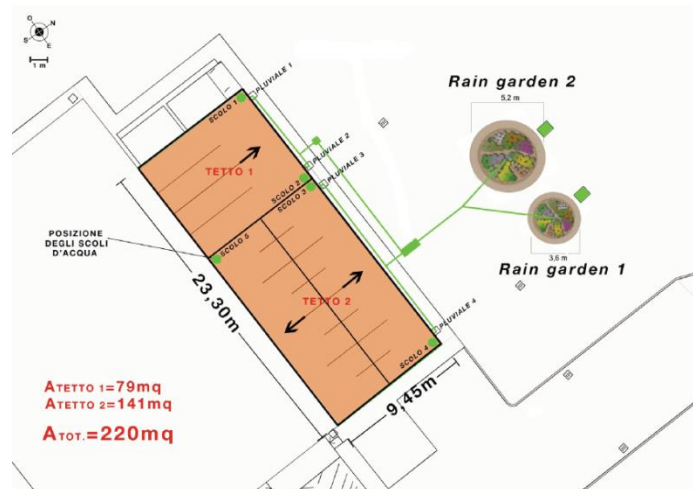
Progetto in pianta dell'edificio (Simionato, 2011).
